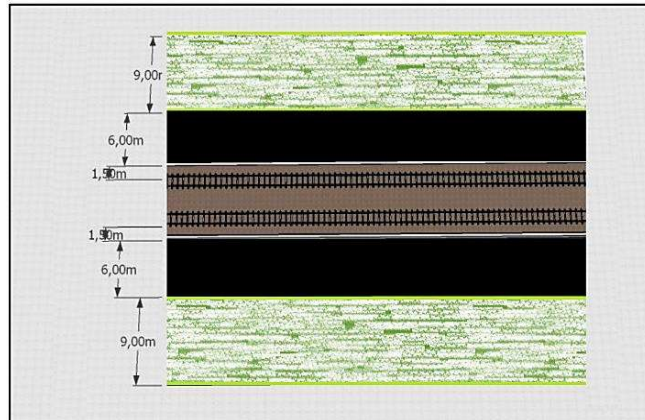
Ruang Bebas Lebar Jalan Rel 1067 mm pada Lengkungan.
